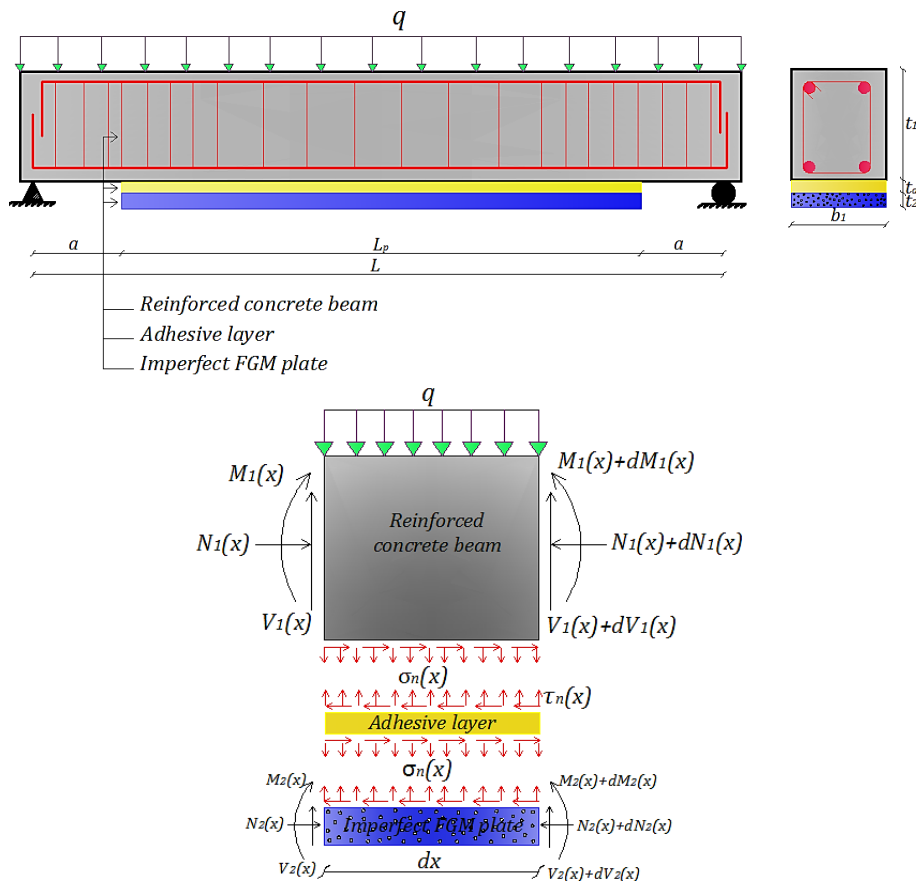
Poutre simplement appuyée renforcée par une plaque FGM collée [141].
